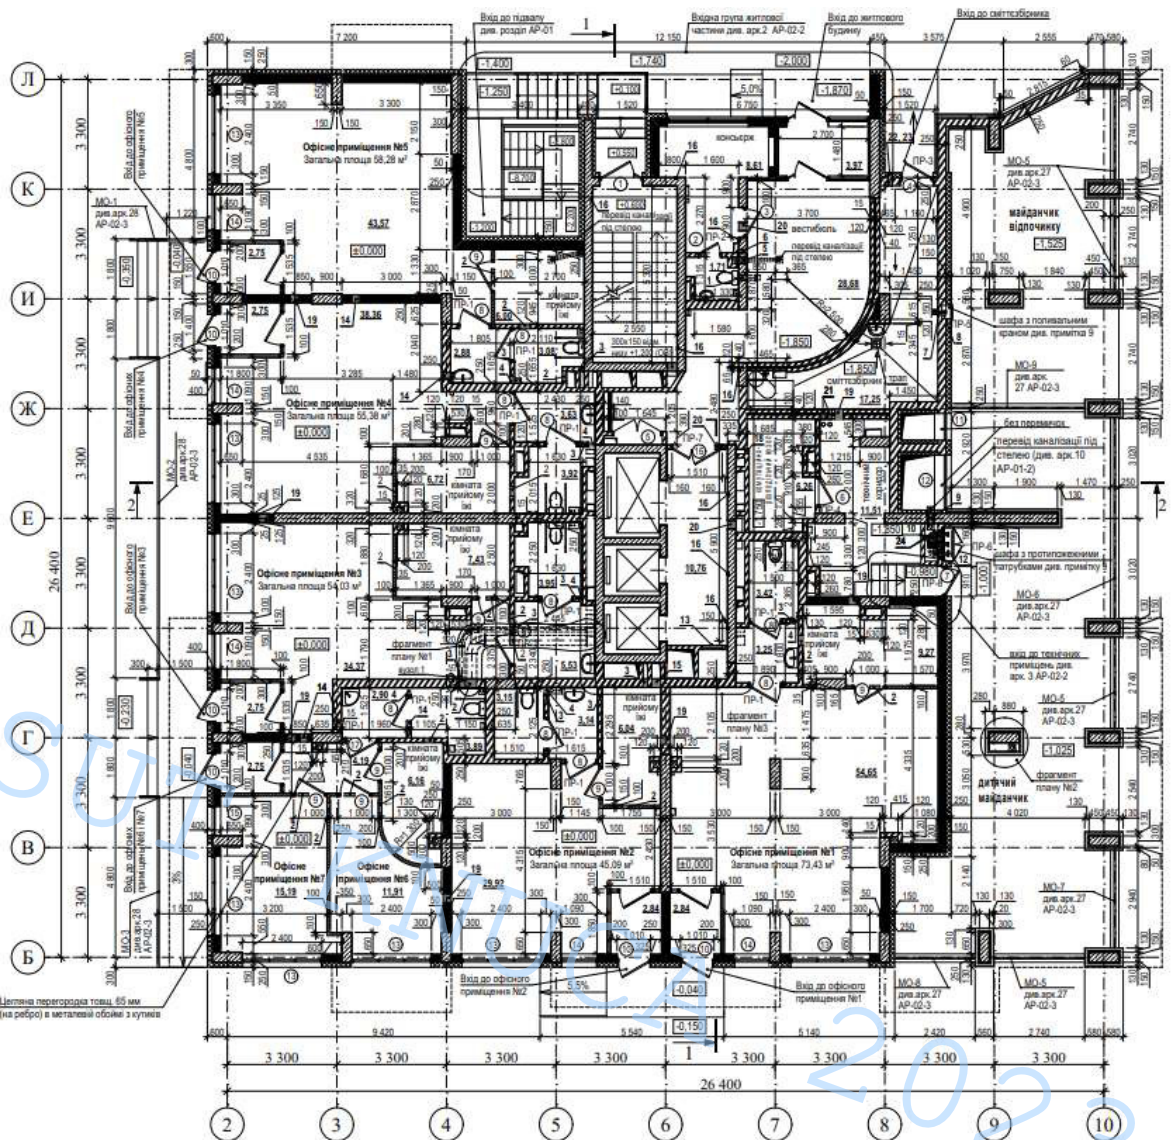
План на позначці, де будуть розташовані осадкові марки
